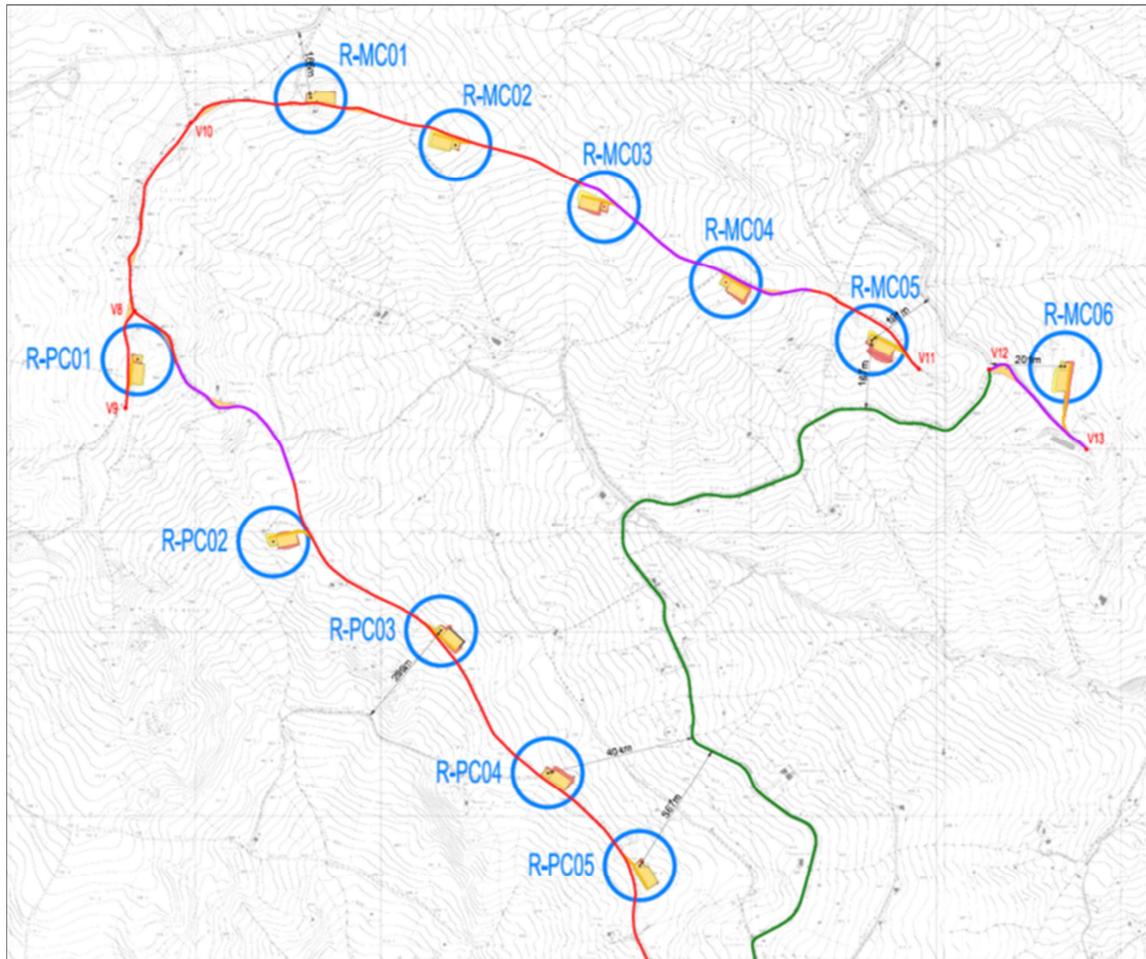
Planimetria piazzole e viabilità d'impianto (area sud)
